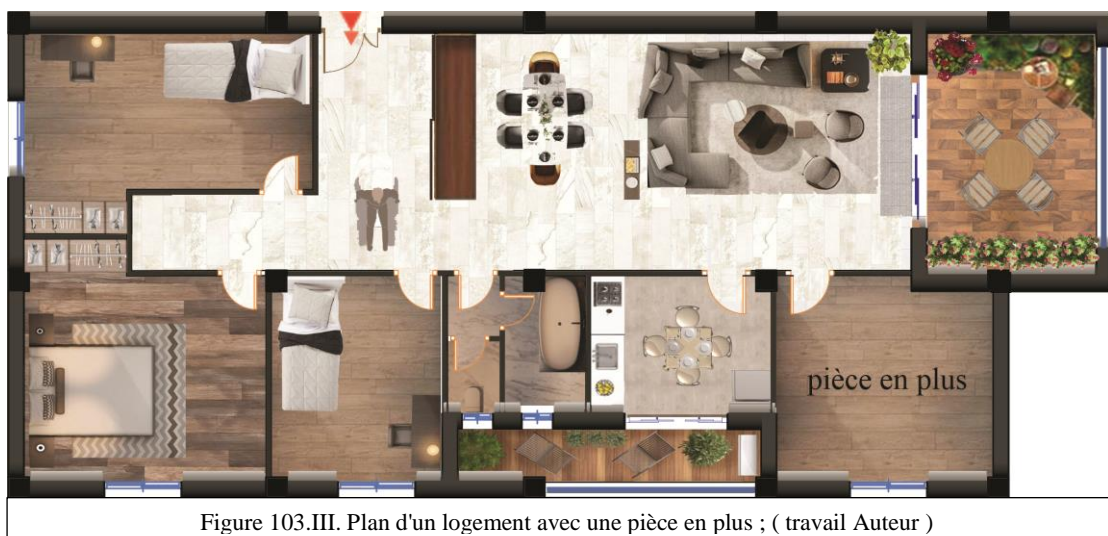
III. Plan d'un logement avec une pièce en plus ; (travail Auteur)
